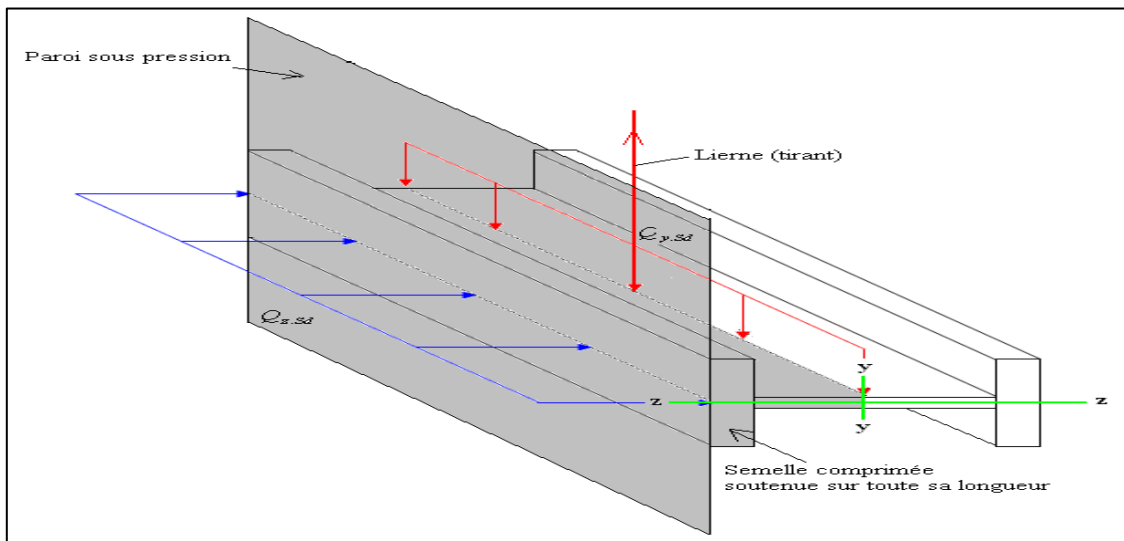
Semelle comprimée soutenue sur toute sa longueur.
